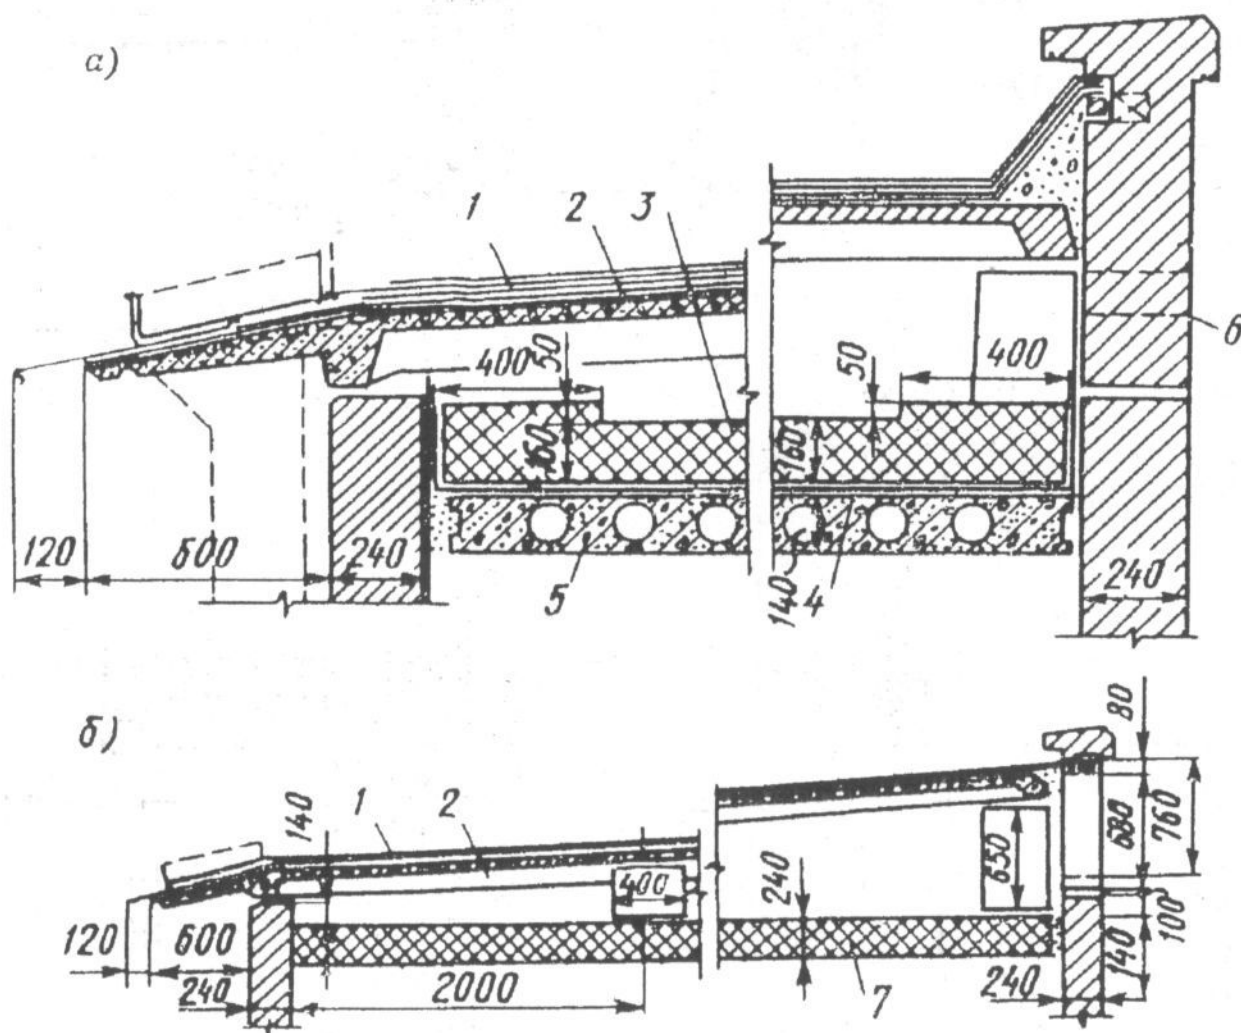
Конструкция бесчердачной вентилируемой крыши
